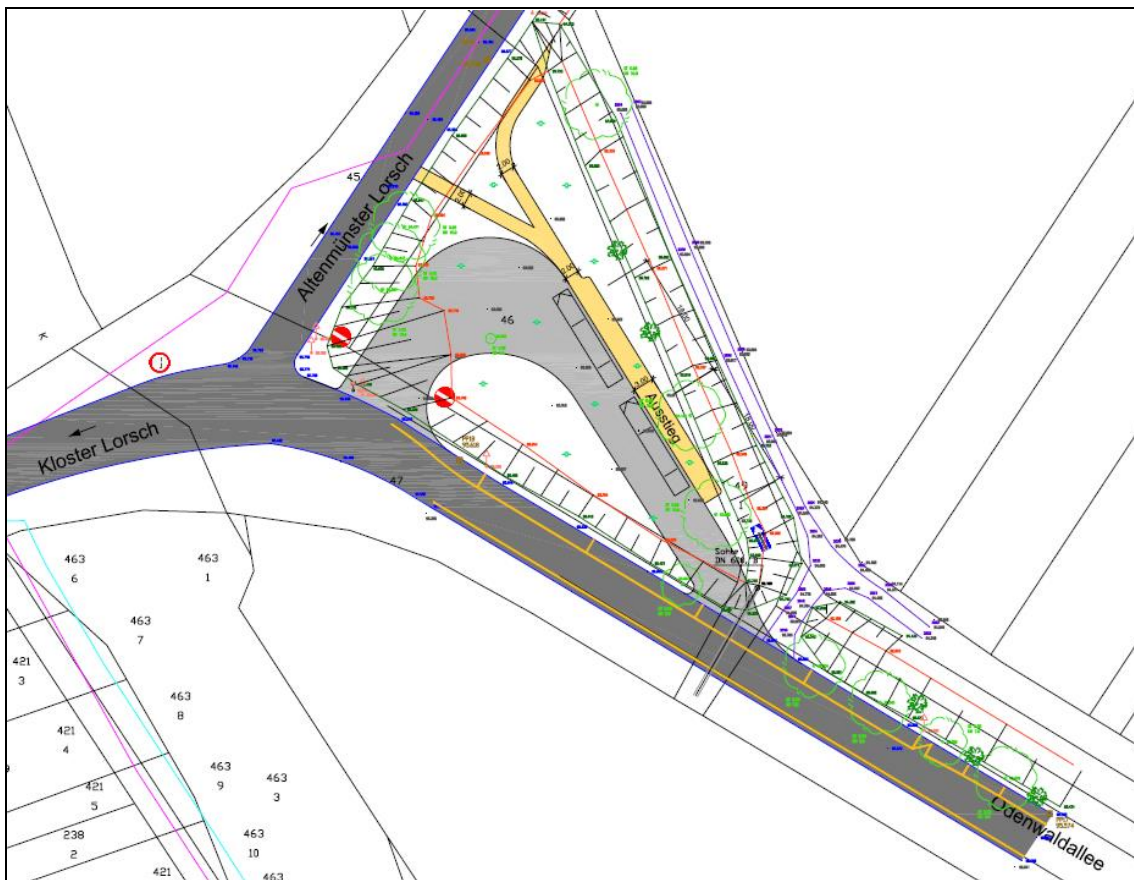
Buswendeanlage Odenwaldallee: Lageplan Konzept.
